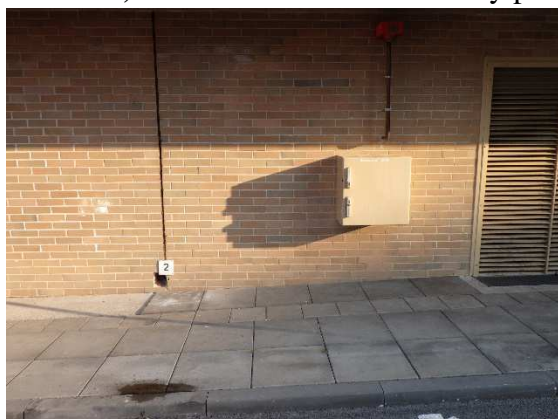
;18--sonda NS-A8 celkový pohled, obnažená část;
